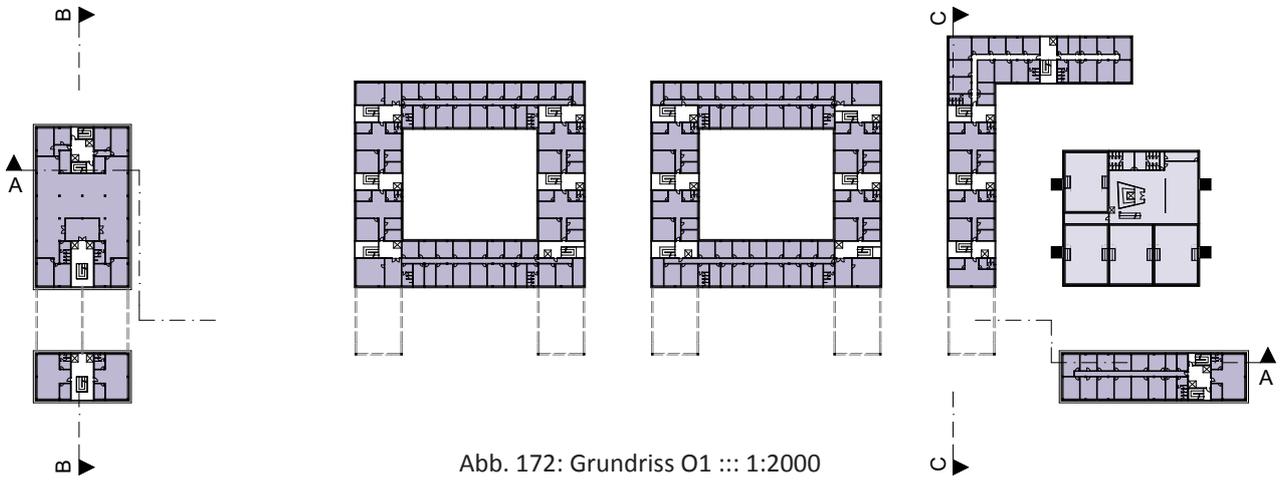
Grundriss O1 ::: 1:2000
